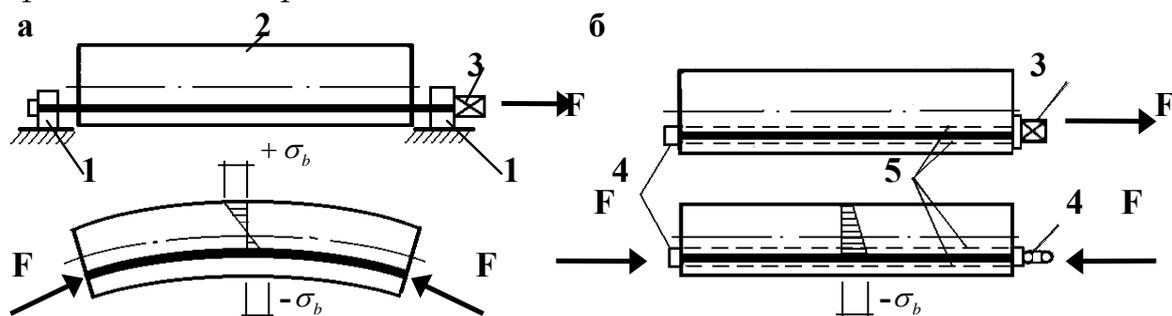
Схемы предварительного натяжения арматуры железобетонных конструкций:
